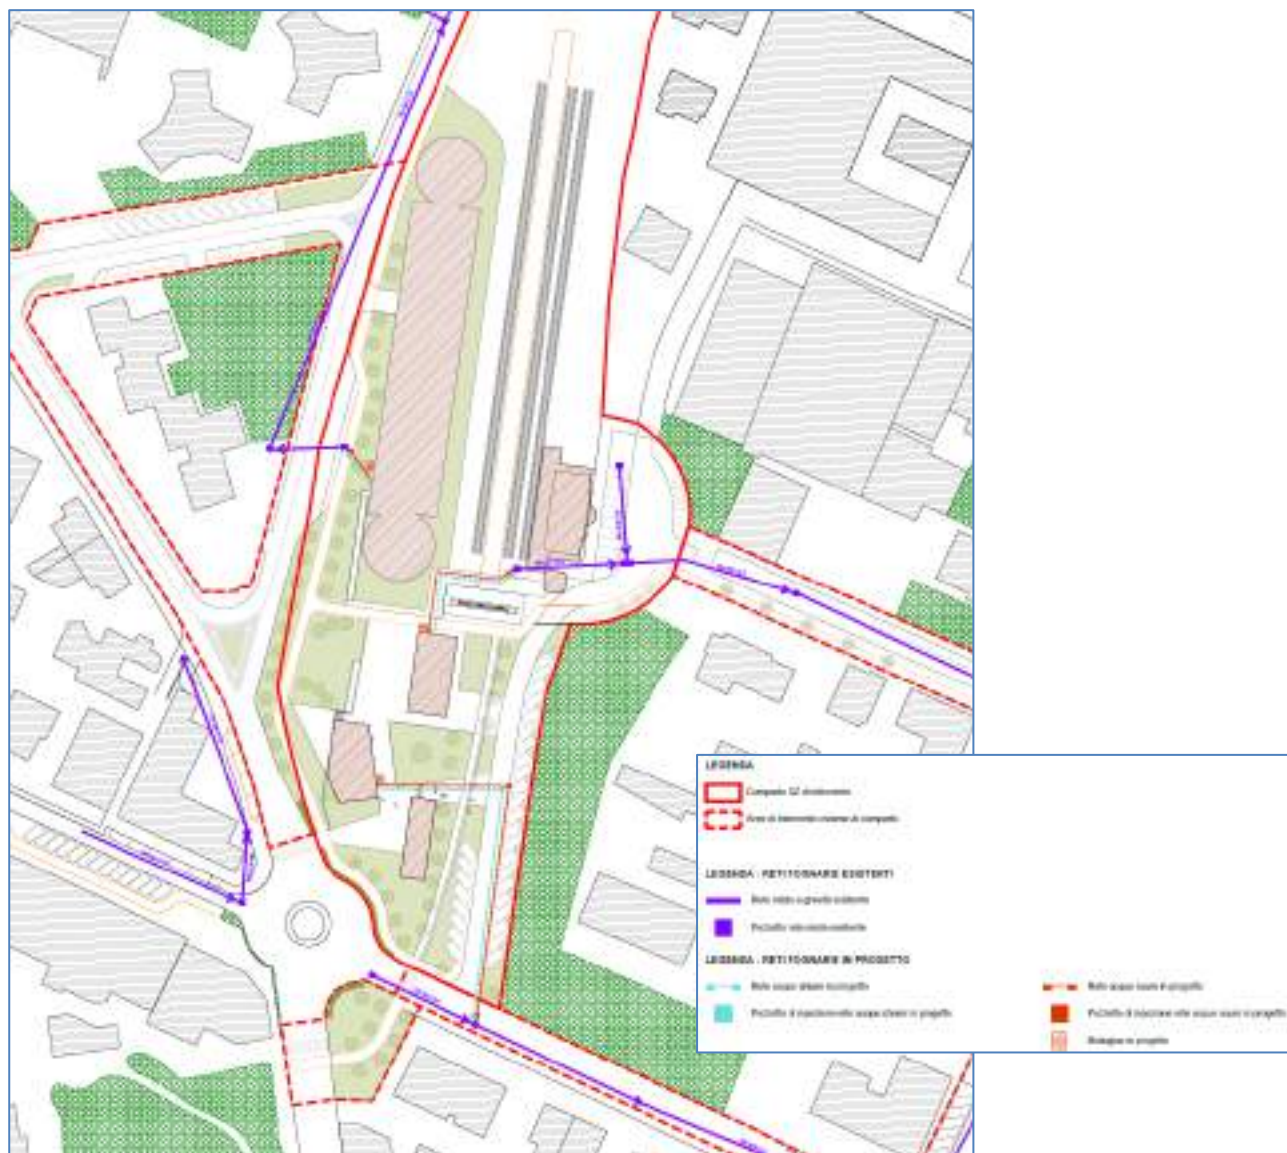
SCHEMA DELLE RETI DI PROGETTO (FOGNATURE) ESTRATTA DALLE TAVOLE DI PROGETTO
